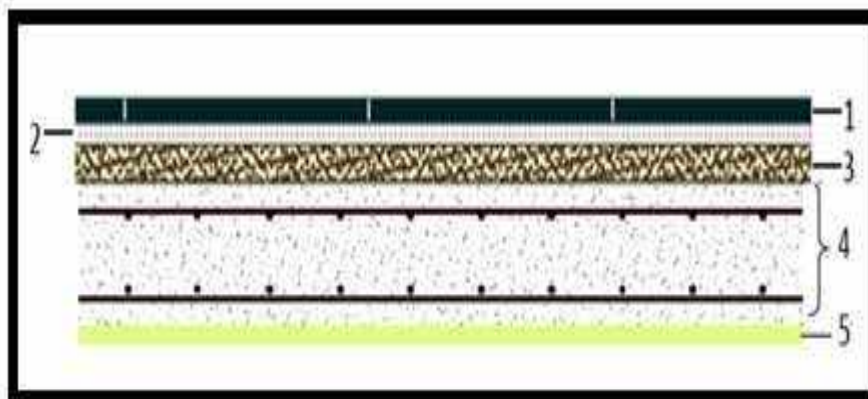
Composants d'un plancher étage courant dalle pleine.
